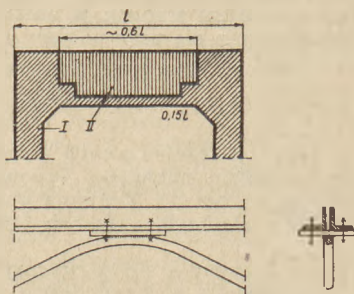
Połączenia prętów konstrukcji zbrojeniowych, okrągłych, rurowych i kątowych
